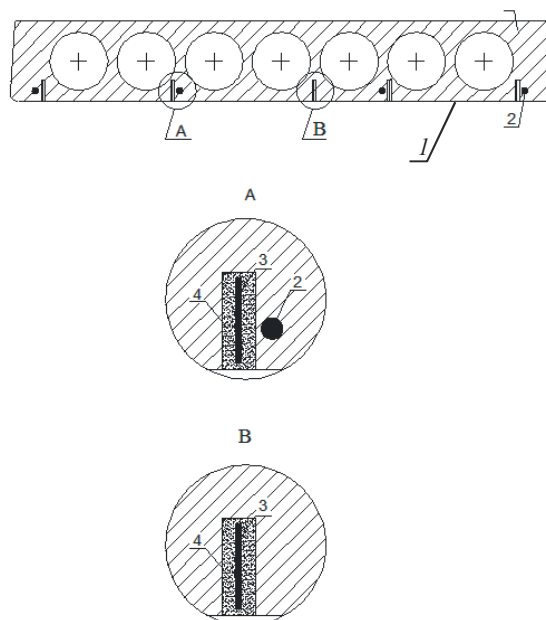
Изобретенный способ усиления многопустотных железобетонных панелей перекрытий углеволоконными пластинами: 1 – усиливаемая плита, 2 – основная арматура, 3 – дополнительная арматура, 4 – Омоноличивающий слой на основе эпоксидных составов
